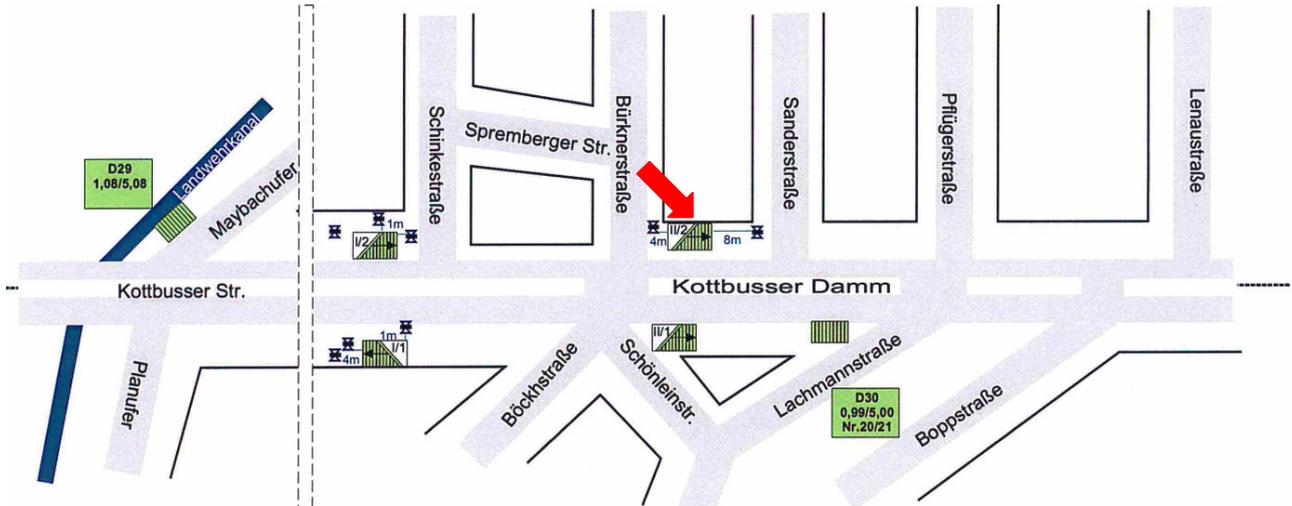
Lageplan vom U-Bahnhof Schönleinstraße mit Kennzeichnung der Lage der Anschlussstelle Feuerwehr-Gebädefunk am Ausgang
